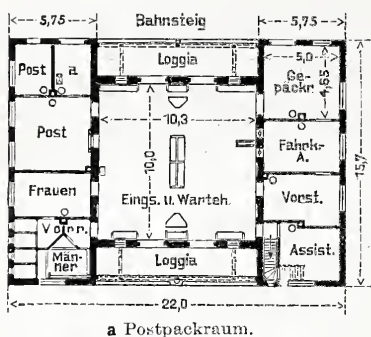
Bahnhof Lersöen. Erdgeschoß. (1:500)
